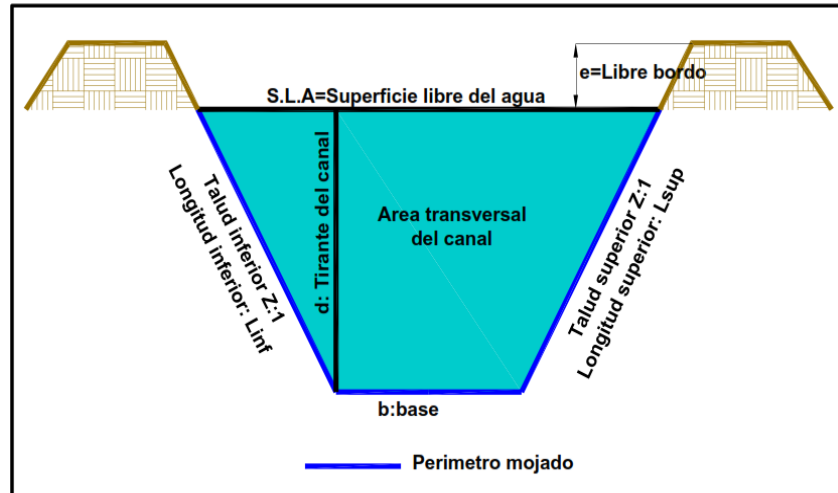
Parámetros de diseño en la construcción en canales de tierra
